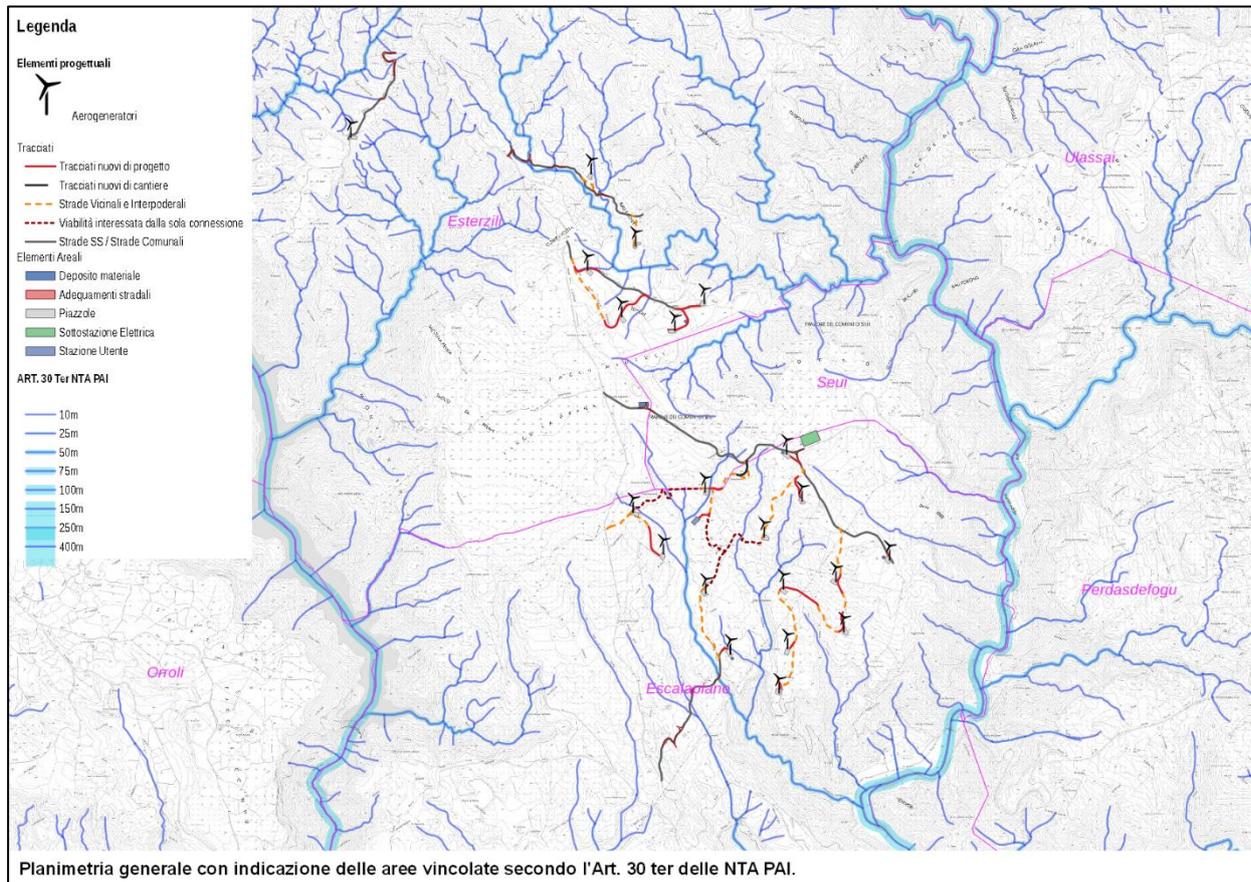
Planimetria generale con indicazione delle aree allagate interessate dall'Art. 30 TER.
